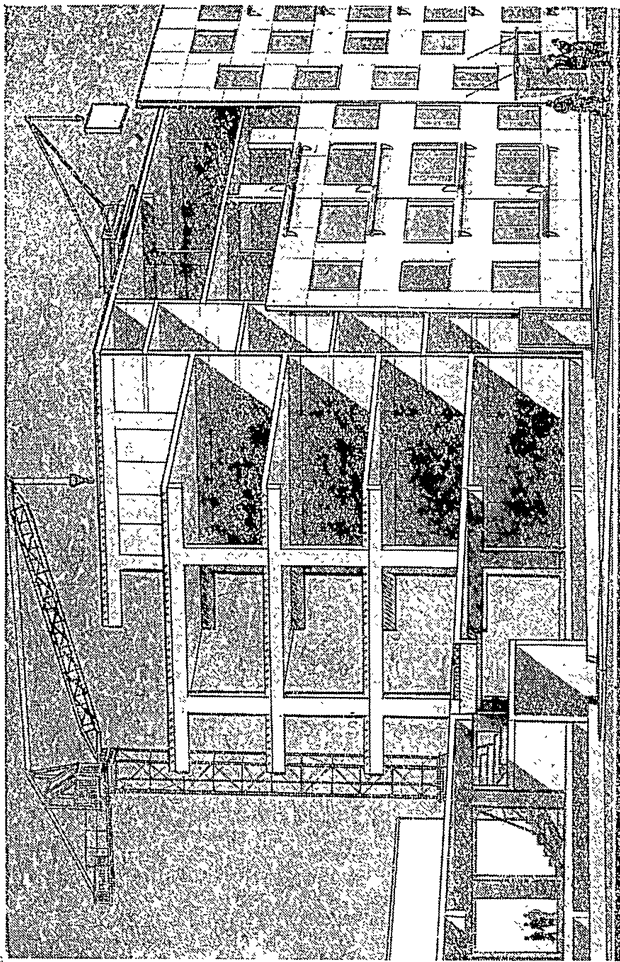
Конструктивная схема жилого дома с несущими поперечными конструкциями и навесными стенами из газобетонных блоков.
